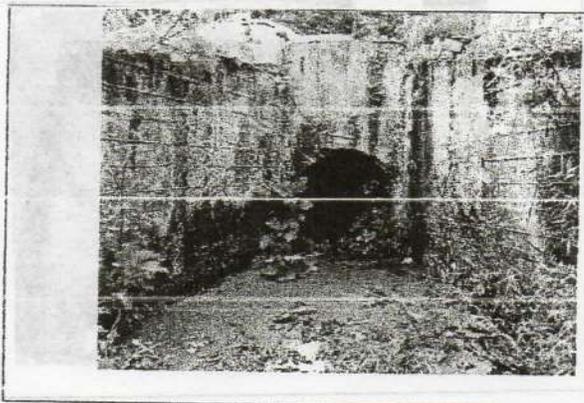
Vista de conjunto donde se observa el lugar sobre la alcantarilla.
